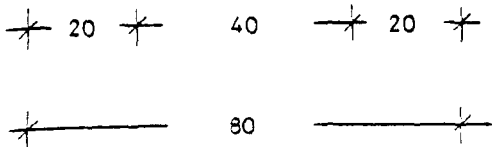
Details zu Bild 23, Spannbetonscheiben
